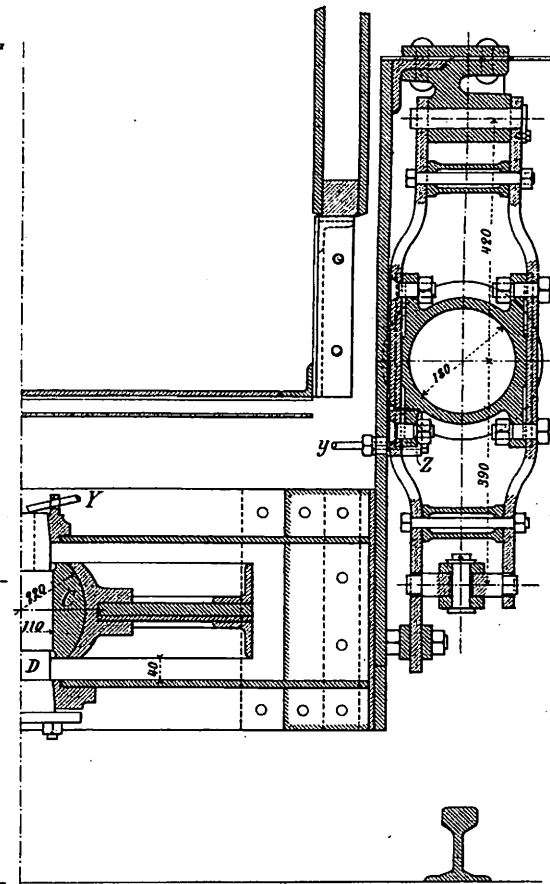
Grundriss und wagerechte Schnitte.
